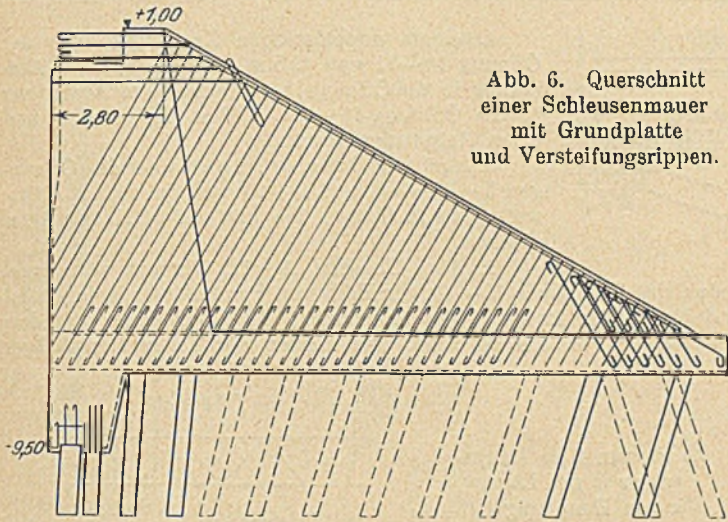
Querschnitt einer Schleusenmauer mit Grundplatte und Versteifungsrippen.
